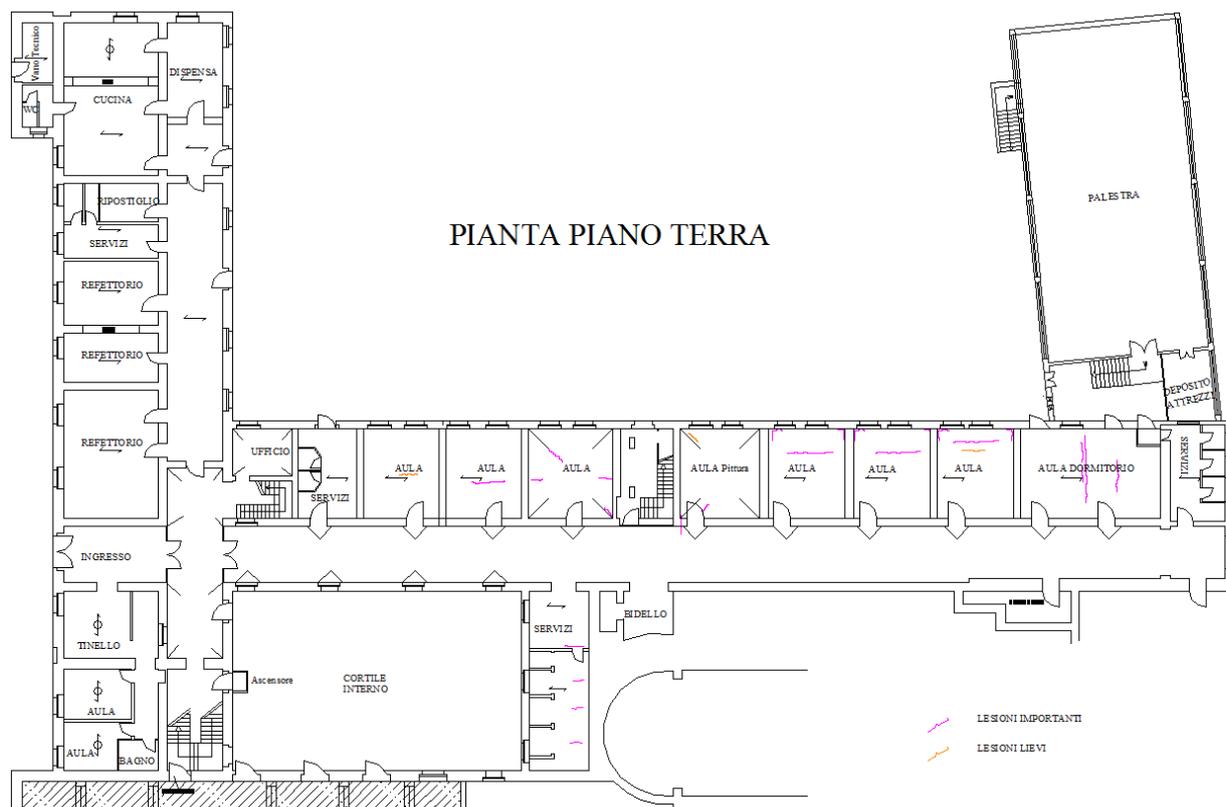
Rilievo quadro fessurativo piano terra (Allegato 4)
